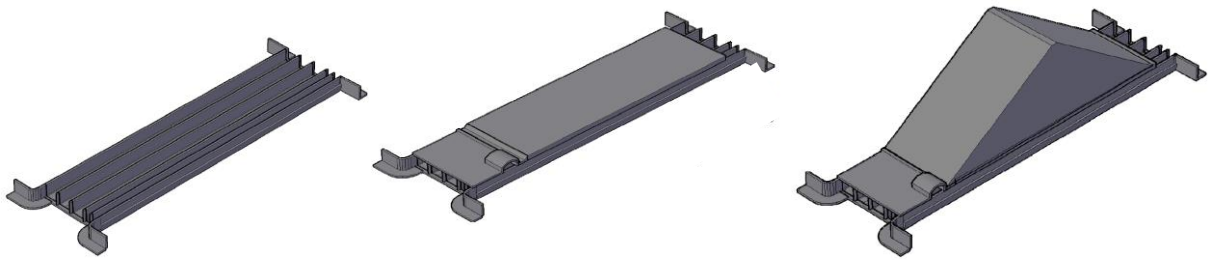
Etapas constructivas del desvío de la Presa NK.
